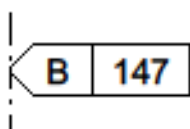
Referencat e detalit që figurojnë në të njëjtin plan
